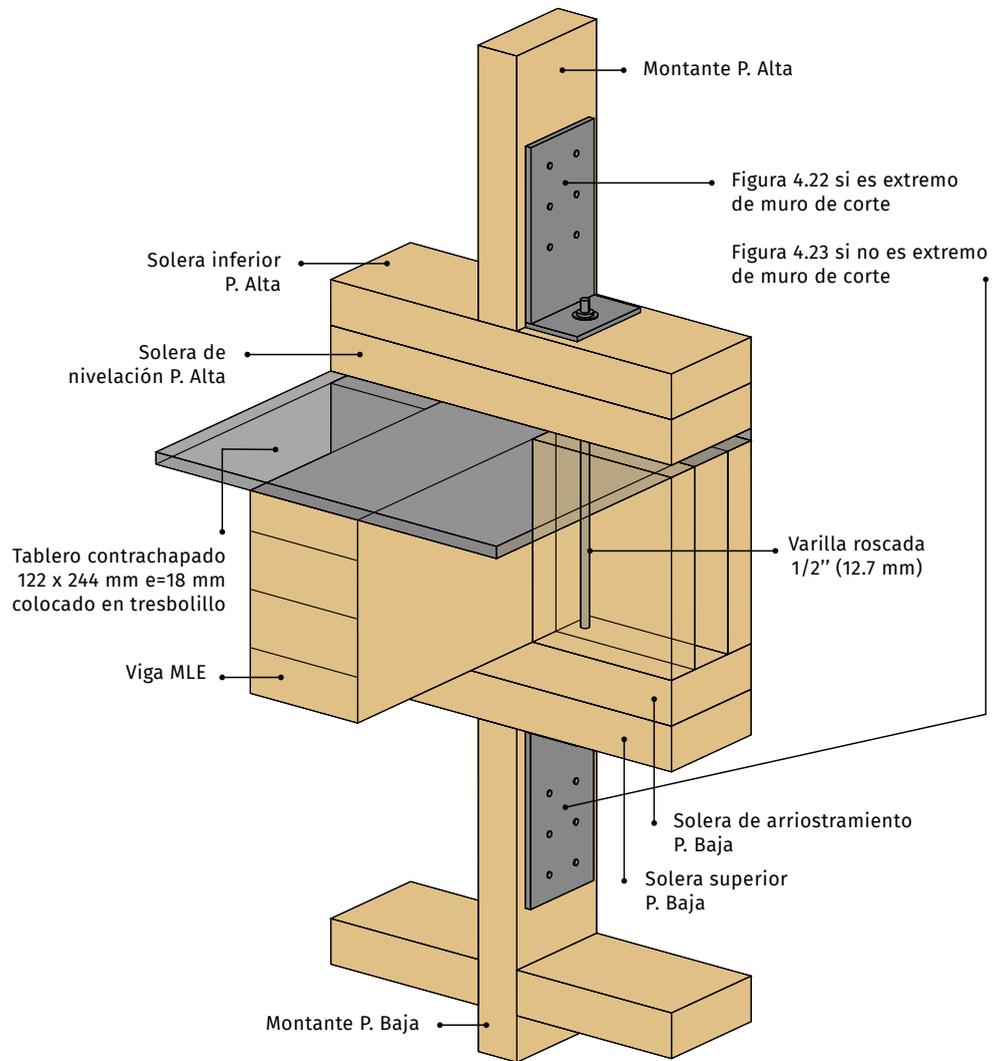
Detalle de unión de dos vigas concurrentes sobre el muro portante interior
